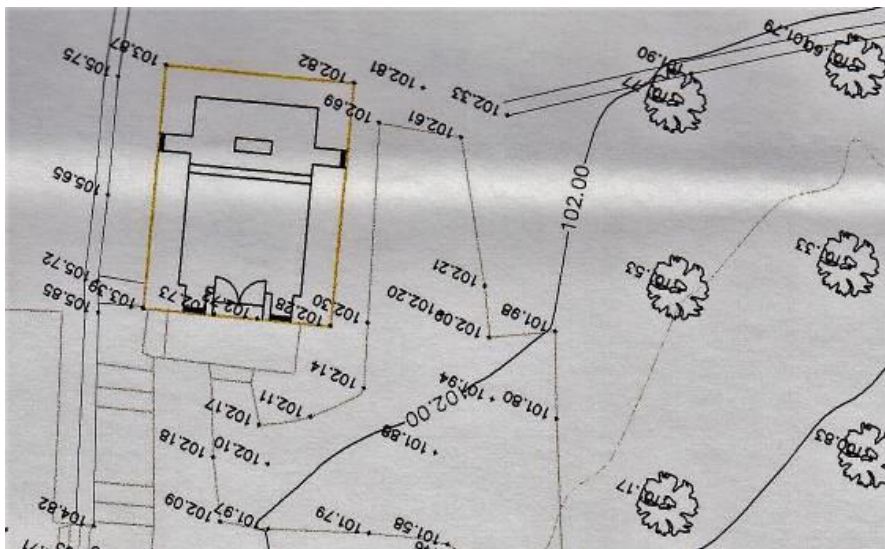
Pormenor de planta de implantação / arranjos exteriores. Capela da Quinta da Salada. Escala 1 / 200<sup>825</sup>.
